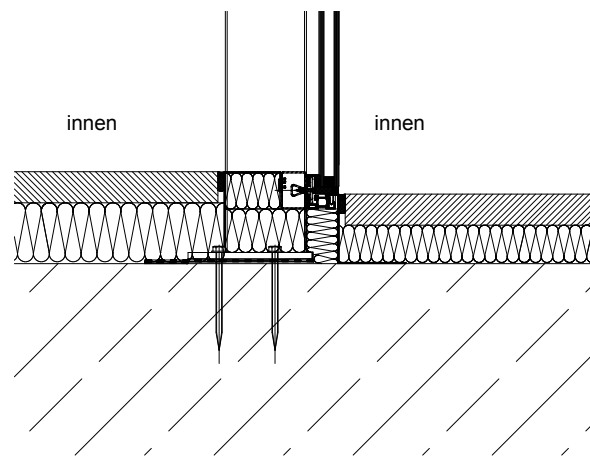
Pfosten Riegel Fassade Anschluss unten: M 1: 10
